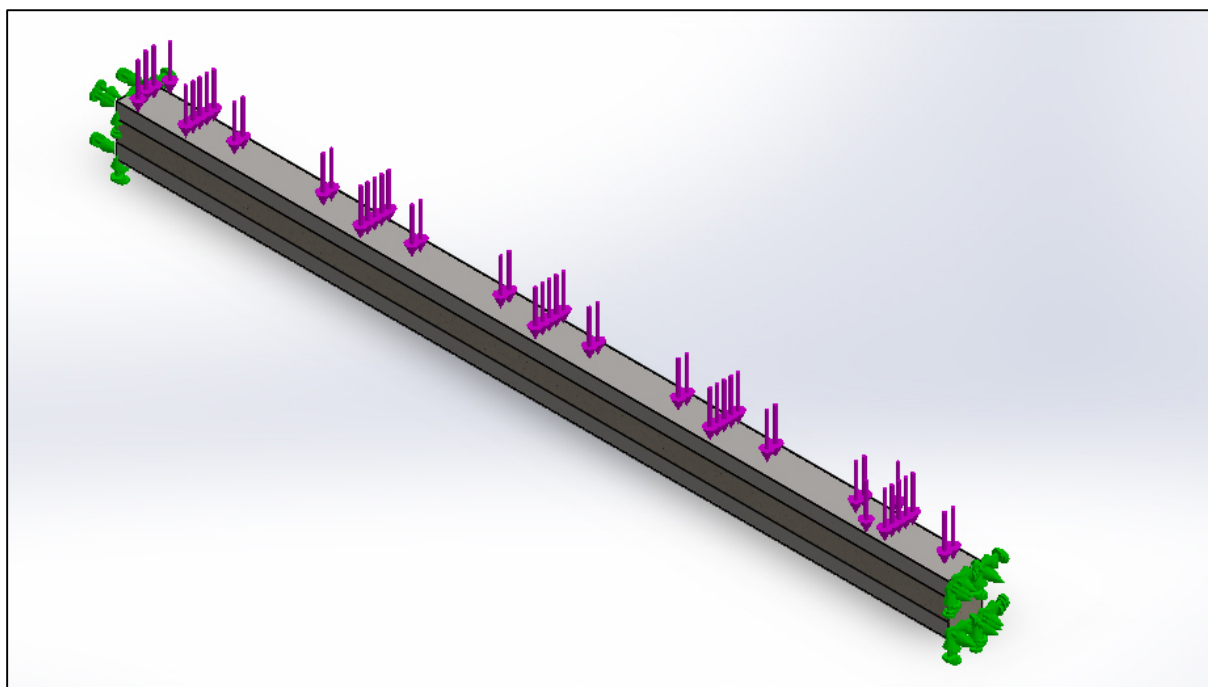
Visualização das condições de apoio e cargas para a viga de betão com a aplicação do reforço 3b.
